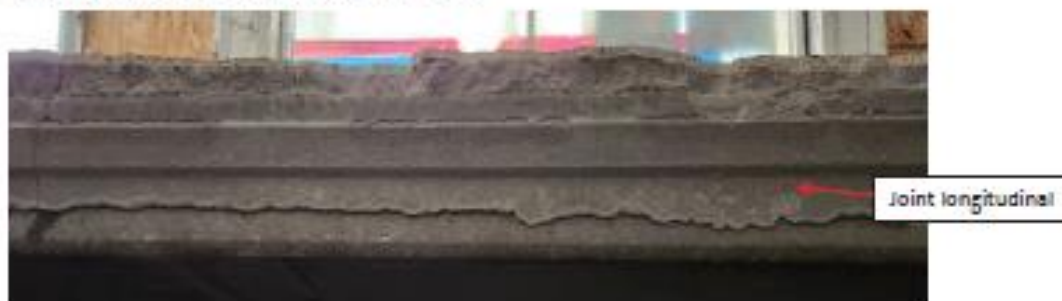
Joint longitudinal rempli de béton et trace du profil latéral de la dalle (Source : CNESST)
